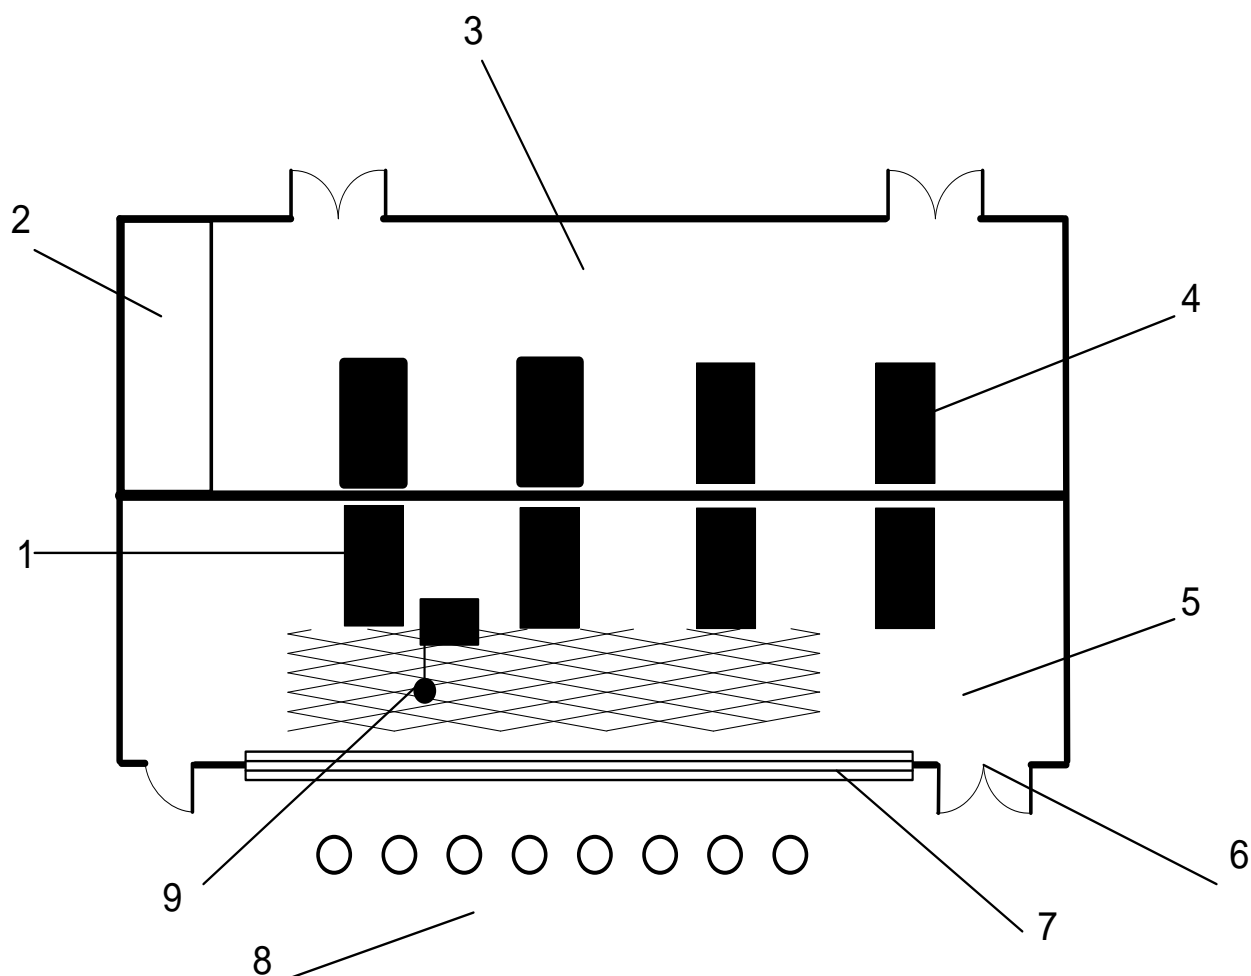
Схема здания общего укрытия НПС-3
